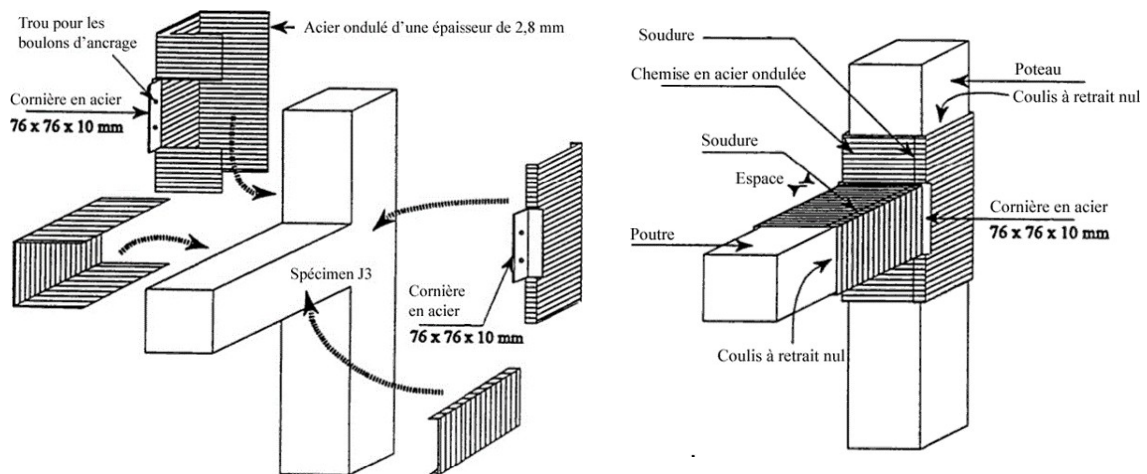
Chemisage des zones nodales poteaux-poutres Application particulière pour les cadres sans dalles [3]
